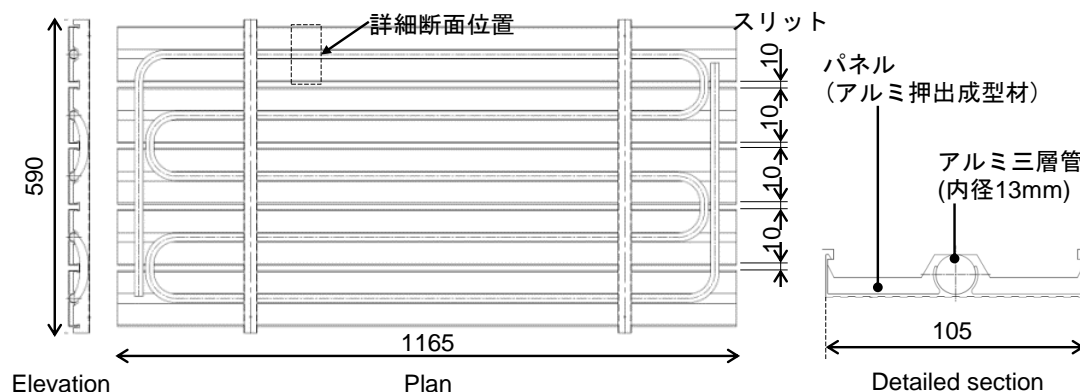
高開口率天井放射パネル立面図・平面図・詳細断面図
